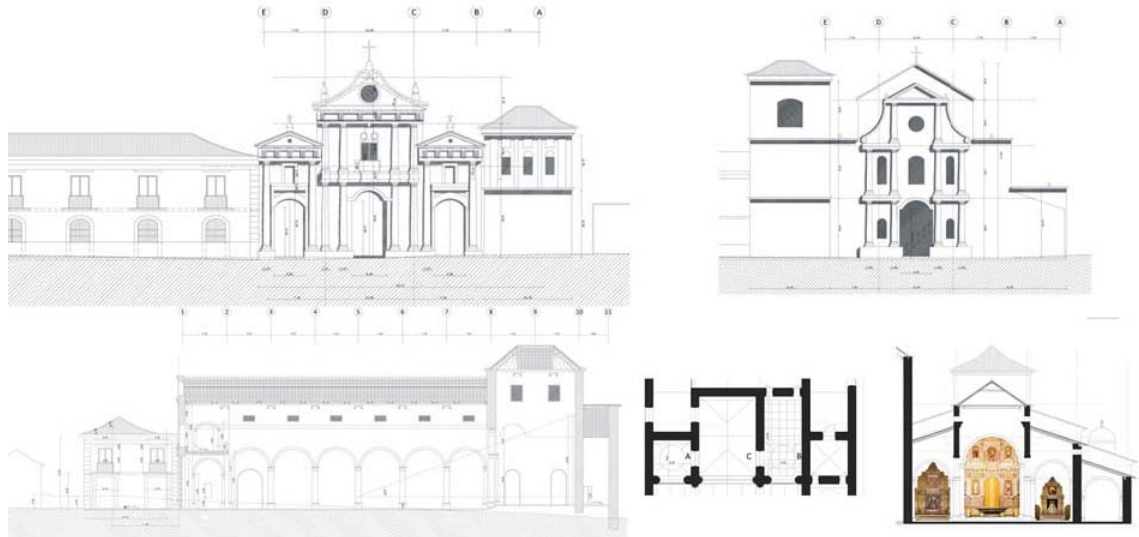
Fachadas, secciones longitudinales y transversales del templo de San Jacinto reconstruido en su aspecto en los siglos XVIII y XIX
